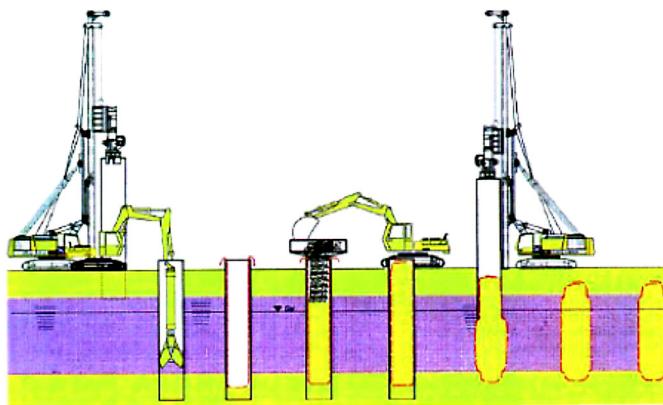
Схема установки грунтовой сваи в оболочке из геосинтетического материала методом грунтозамещения
